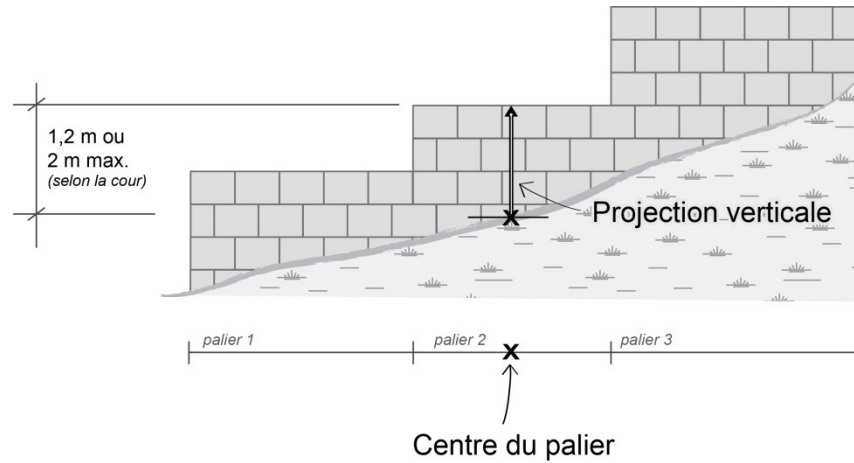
Méthode de calcul pour la hauteur d'un mur de soutènement situé sur un terrain en pente
